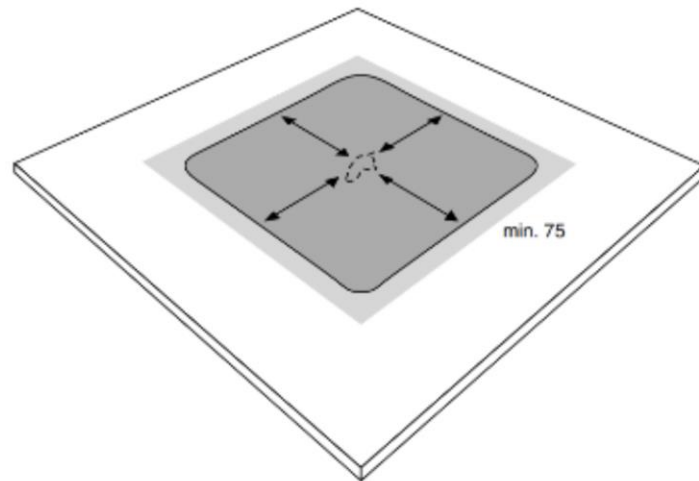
Traitement d'une traversée de toiture, en QuickSeam Cover Strip
